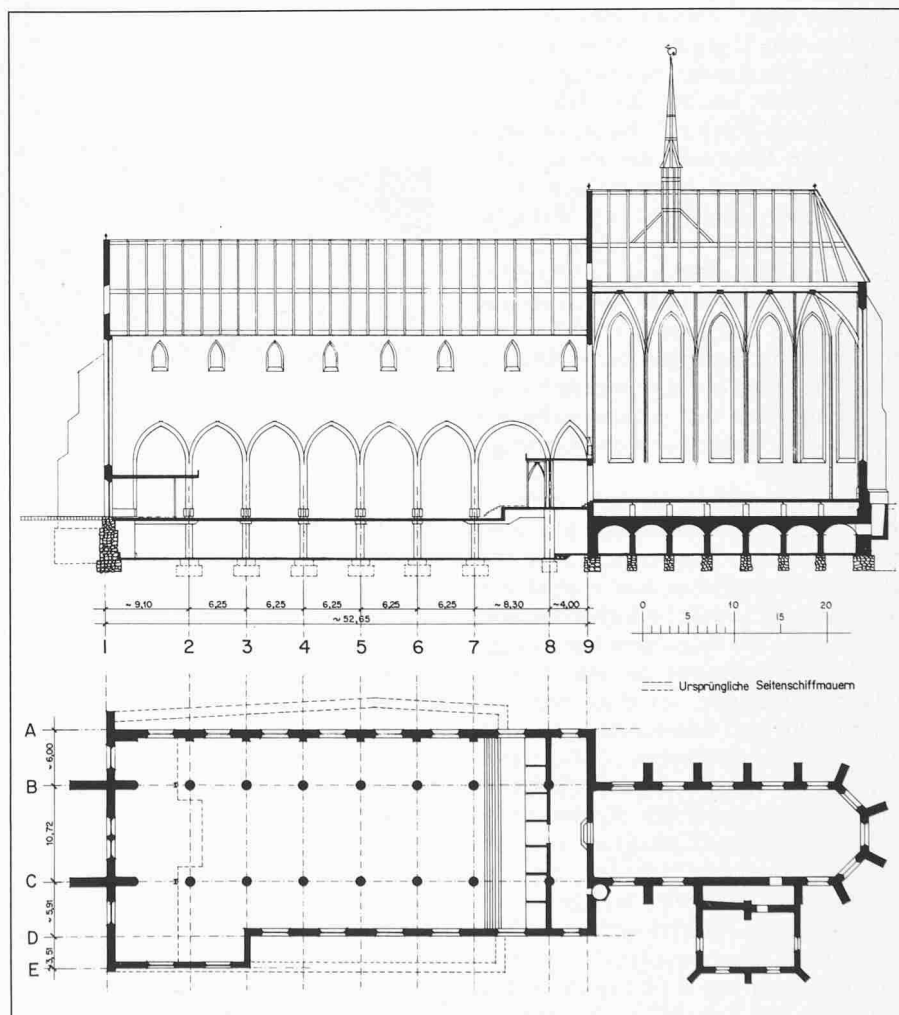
Längsschnitt und Grundriss des Erdgeschosses nach der Renovation. Die beschädigten Pfeiler sind durch genaue Kopien ersetzt worden. Material und Bauweise entsprechen der ursprünglichen Konstruktion. Vor dem Chor steht wieder eine rekonstruierter Lettner. Die verbreiterte Westfassade hat ihre ursprüngliche Gestalt zurückerhalten. Die stillfremden Emporen sind – bis auf eine Galerie zwischen den Achsen 1 und 2 – verschwunden. Das Untergeschoss unter dem Langhaus ist primär eine Sanierungsmassnahme (Beseitigung der Salzurückstände) und subsidiär ein Platzgewinn für das Museum. Der gewölbte Keller unter dem Chor stammt aus dem Jahre 1843
